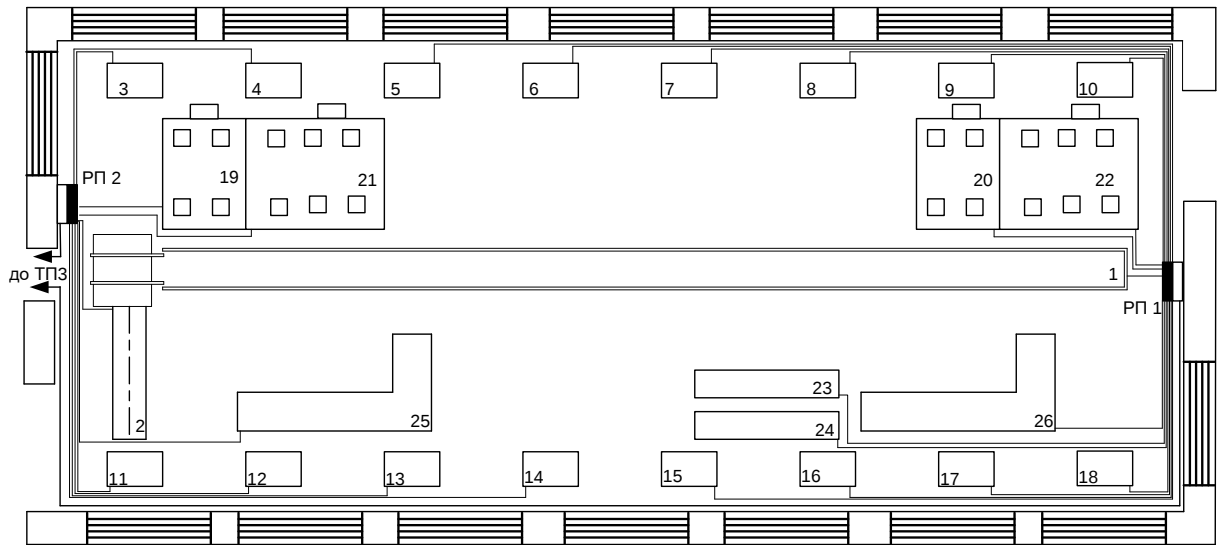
План пакувального цеху з силовою розподільчою мережею
